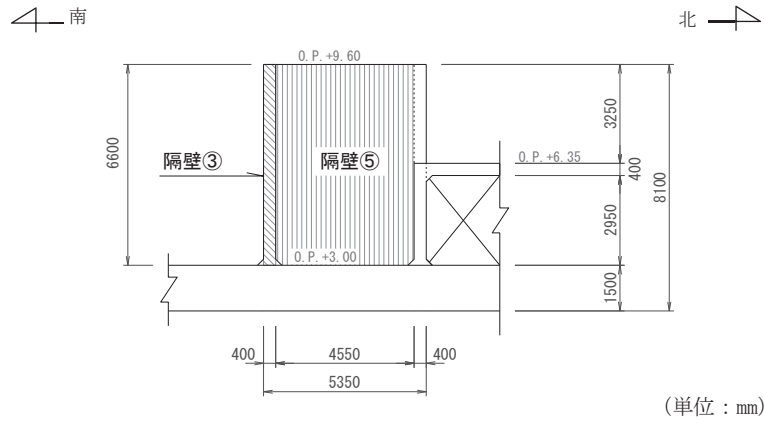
(5) 補機ポンプエリア断面図 (⑤—⑤断面)
